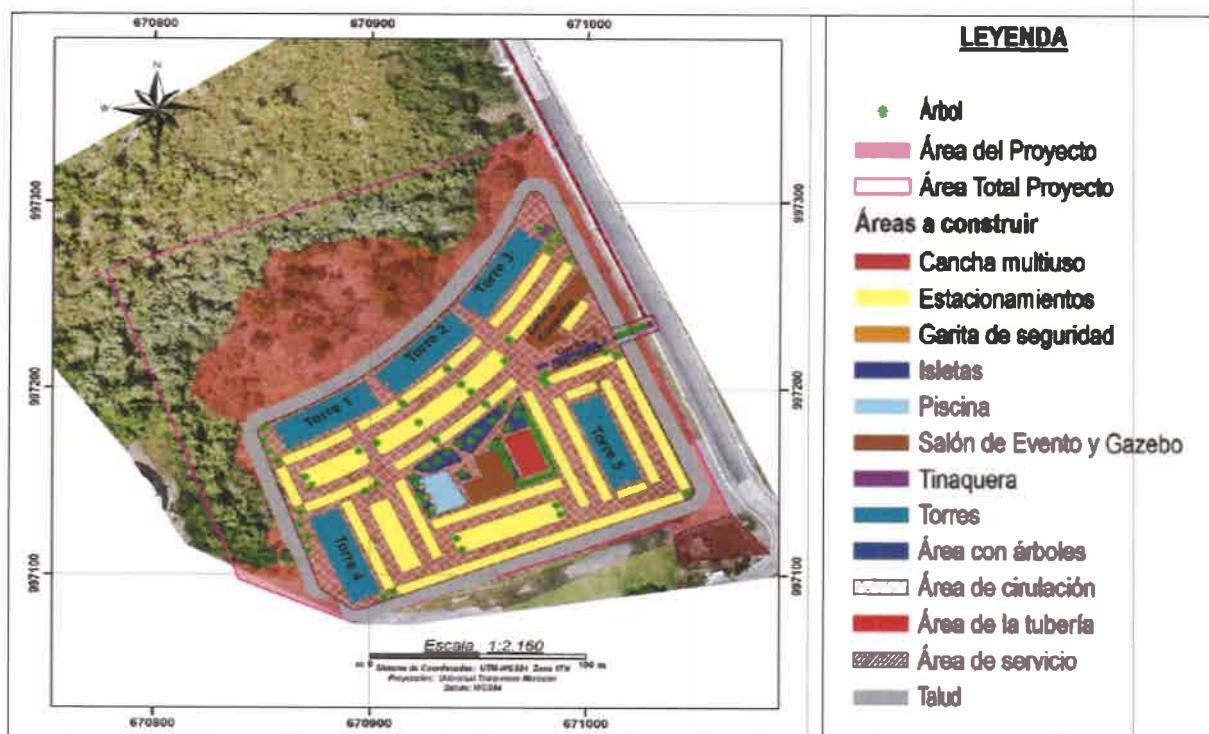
Superficie de construcción del proyecto, 25,556.22 m².
